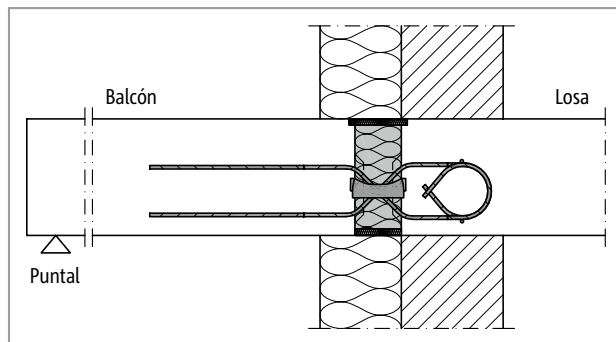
Schöck Isokorb® T tipo Q-VV: Conexión para sistema de aislamiento térmico exterior (SATE) (p. ej., T tipo Q-VV1 hasta Q-VV5)
